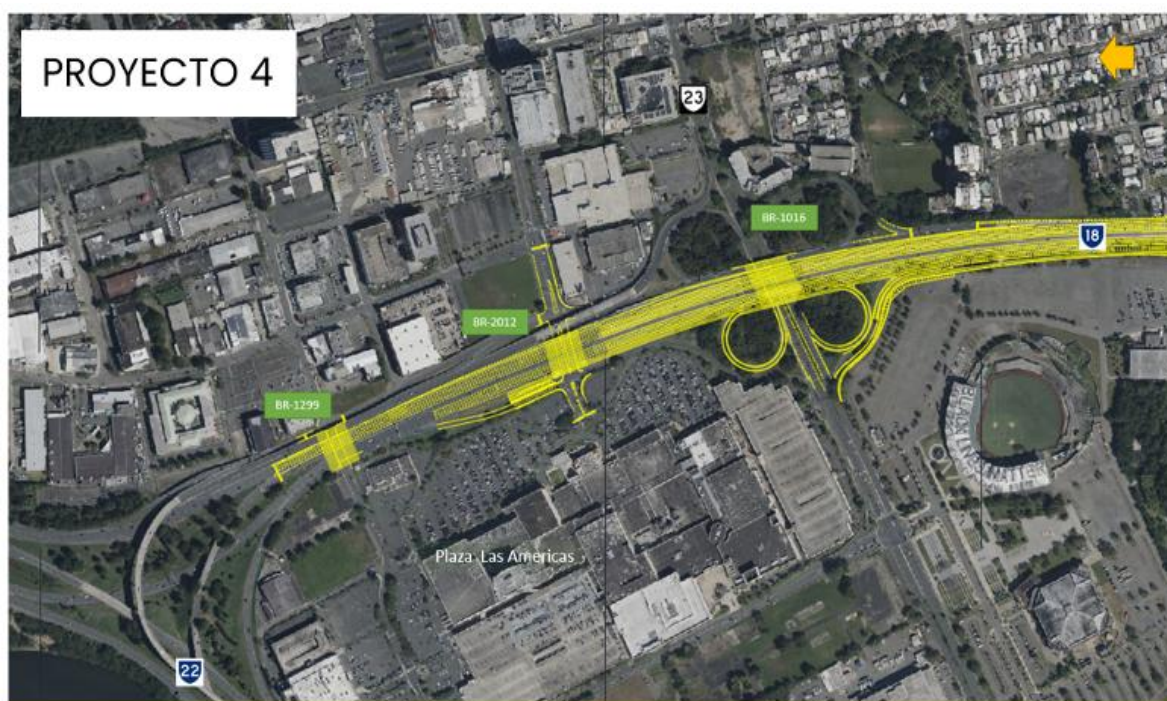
Proyecto 4: Ensanchamiento de la PR-18
